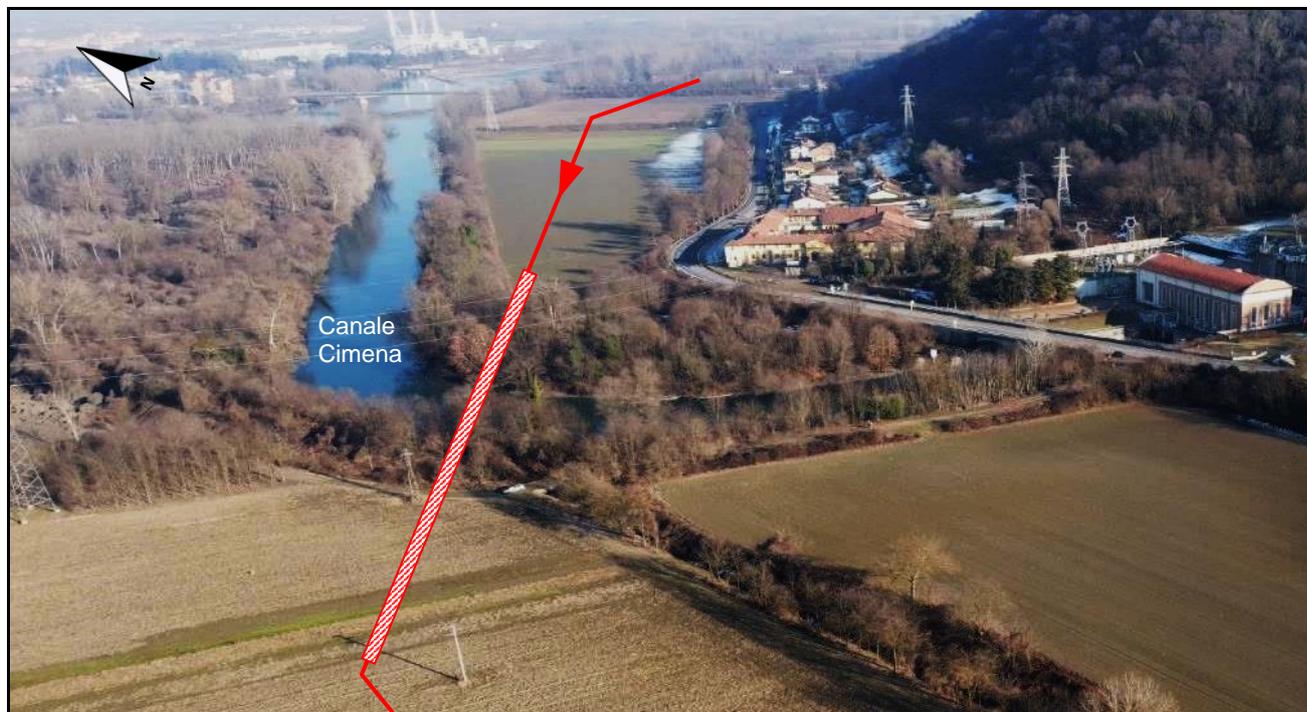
/N - Microtunnel n. 2 - Attraversamento Canale Cimena (PK 4+300)
